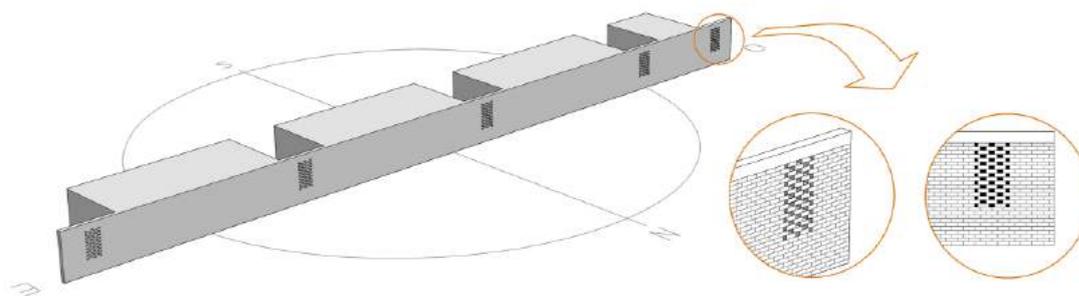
Esquema explicativo del muro norte en la escuela. Fuente: Elaboración propia
